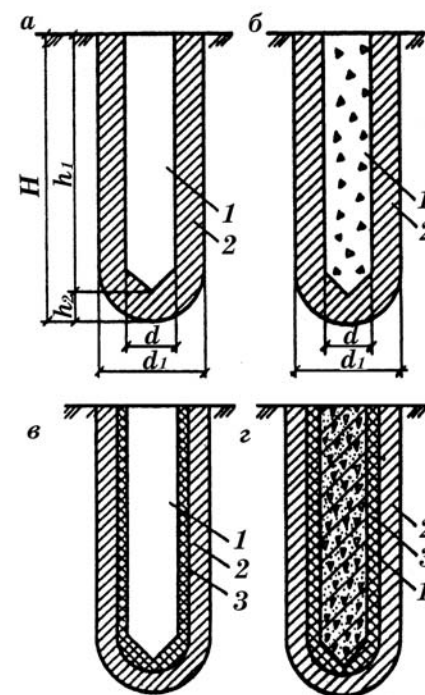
Разрез свай: а – цилиндрическая полая свая: 1 – полость для фундамента, 2 – зона уплотненного грунта; б – заполненная полость: 1 – щебень, песок; 2 – зона уплотненного грунта; в – полость с уплотненными боковыми стенками: 1 – полость, 2 – зона уплотненного грунта; 3 – уплотненный щебнем или песком грунт; г – полость, заполненная бетоном: 1 – бетон, 2 – зона уплотненного грунта, 3 – уплотненный щебнем или песком грунт.
